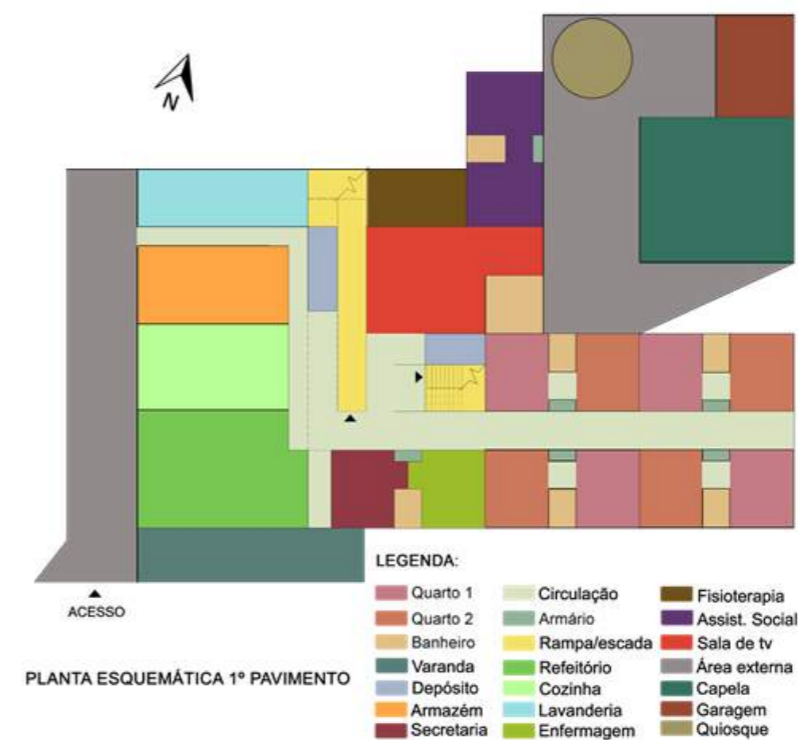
Planta esquemática do 1º pavimento da Instituição “A”.
